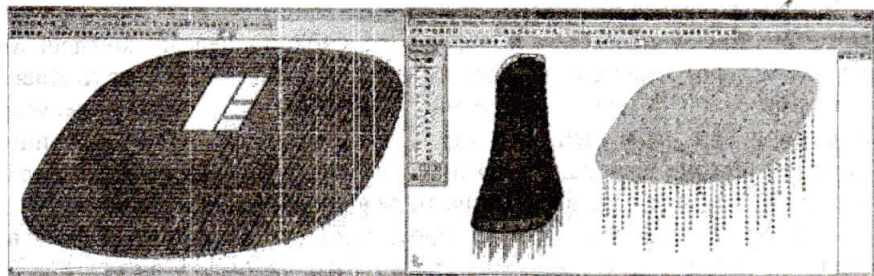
Схема МКЭ каркаса, фундаментной плиты на демпферах и кессонной плиты перекрытия
